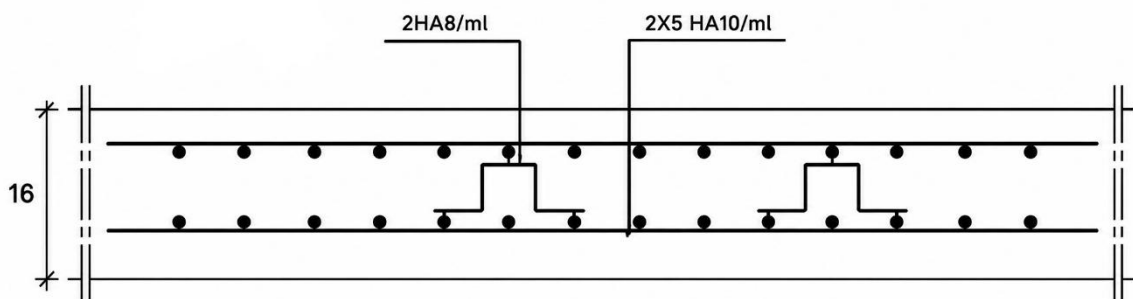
Dessin du ferrailage de la dalle pleine.
